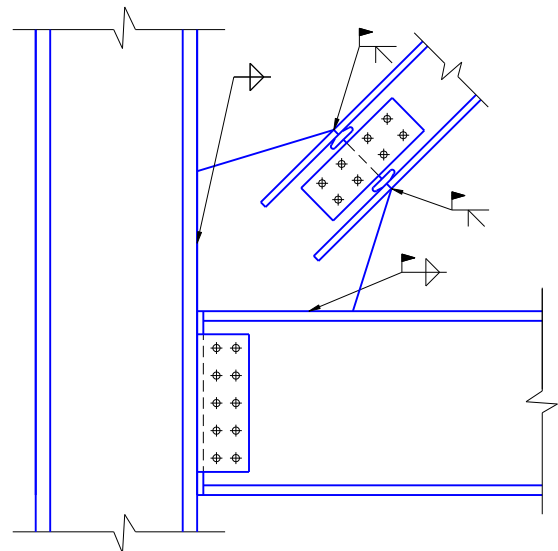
Detalle de conexión inadecuado, debido a que pernos y soldadura resisten en forma conjunta las fuerzas actuantes.
